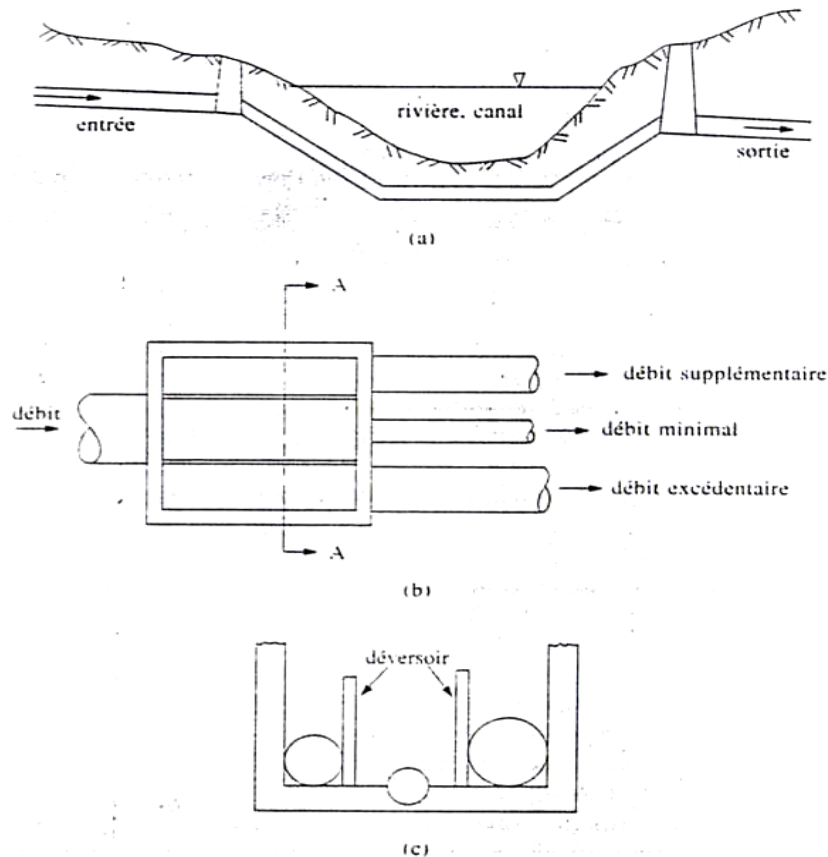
Siphon inversé : a) plan ; b) section verticale ; c) coupe A-A : déversoir d'entrée.
